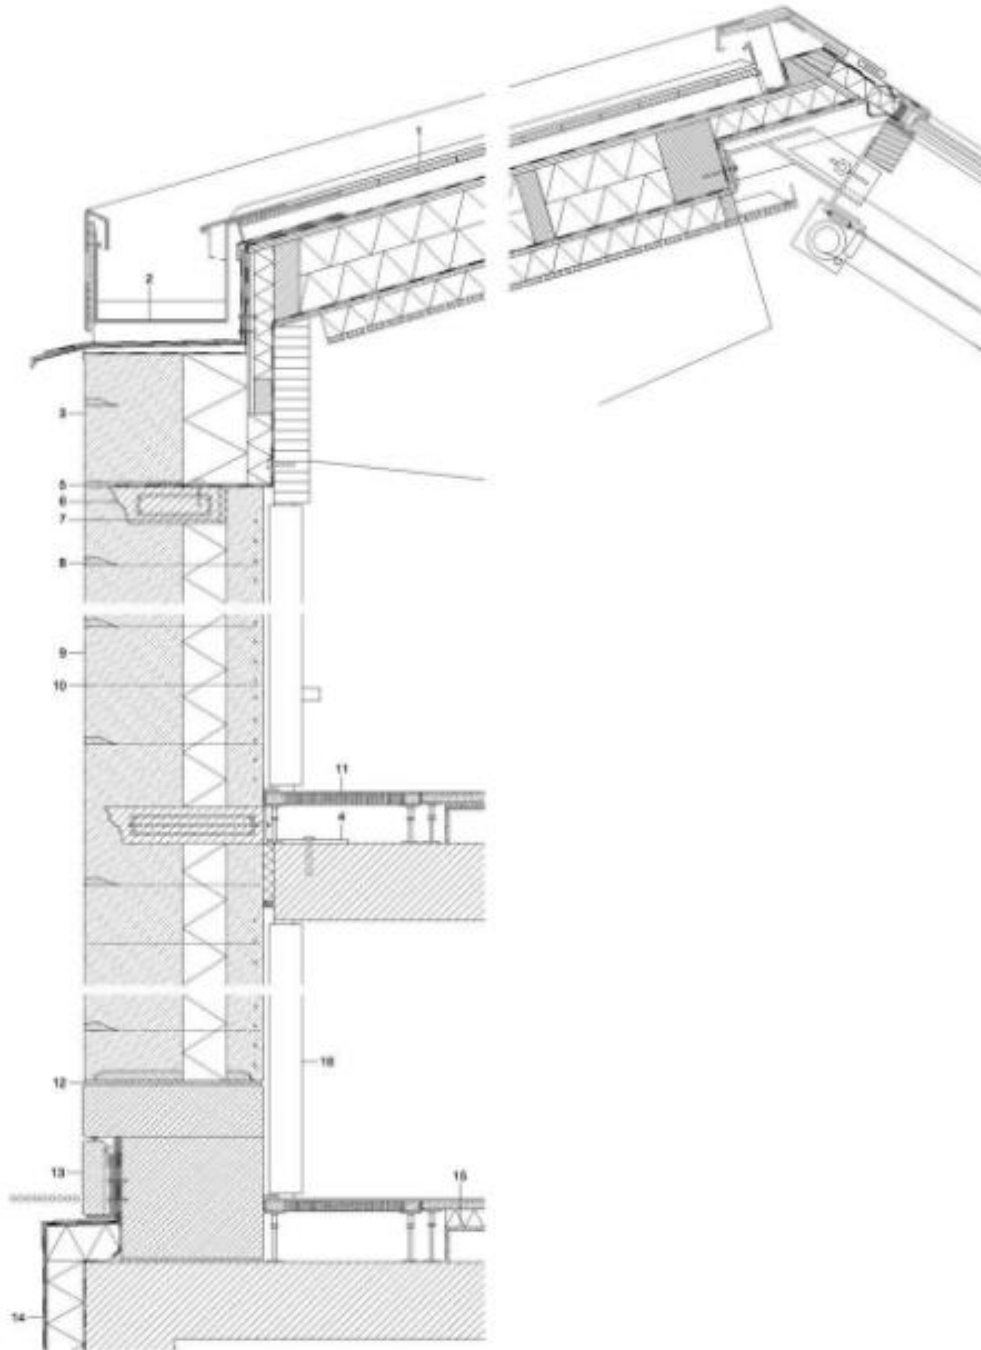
Pormenor da parede em taipa (Arquiteturas de Terra, 2021)
